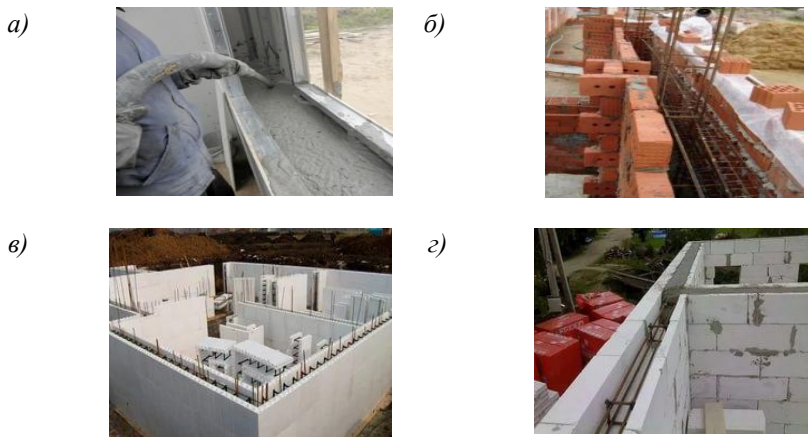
Съемная (а); несъемная (б) опалубки; в) виды установки съемной опалубки; г) устройство армирующего пояса из пеноблоков.
